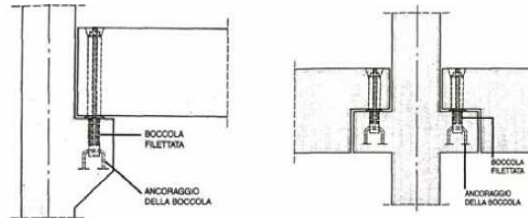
Collegamento trave-pilastro dotato di mensole
